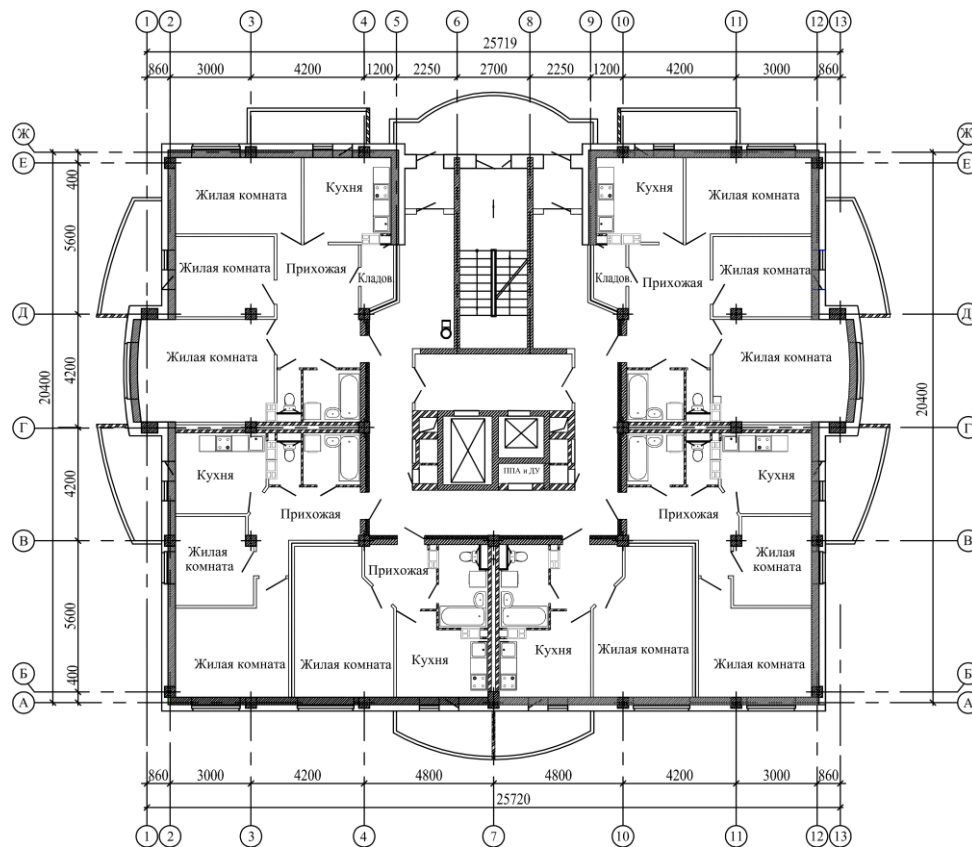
Поэтажный план одноподъездного восемнадцатизэтажного монолитного жилого дома проекта ОКУП «ГОМЕЛЬ-ГРАЖДАНПРОЕКТ» с использованием блоков стеновых с сохранением наружного контура здания
